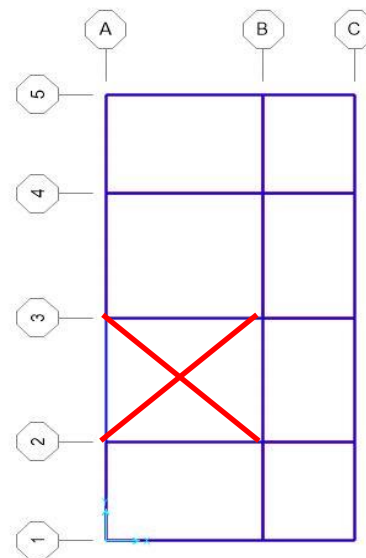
Viste en planta en SAP2000 del Edificio 1
